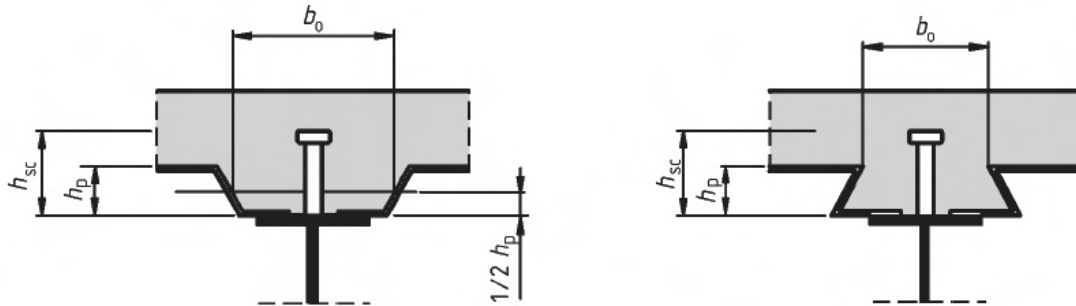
Viga con chapa nervada paralela a la viga
